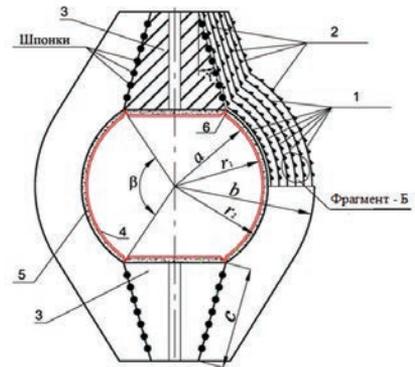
Принципиальная конструктивная схема полусферического КВД (фрагмент Б – см. рис. 3): 1 – вертикальная арматура; 2 – кольцевая арматура; 3 – верхний и нижний торцовые элементы с проходками; 4 – внутренняя герметизирующая облицовка; 5 – теплоизоляция; 6 – компенсатор облицовки
